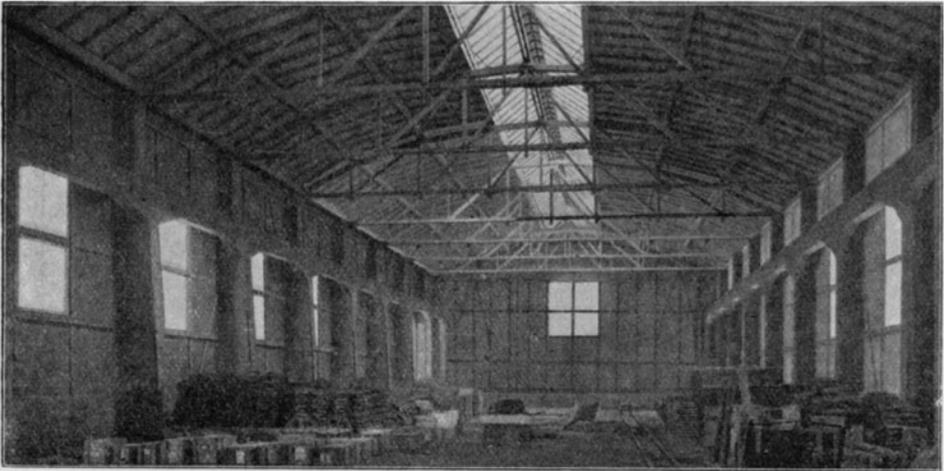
Lagerhalle mit Parabel-Fachwerkbinder und Firstoberlicht.
